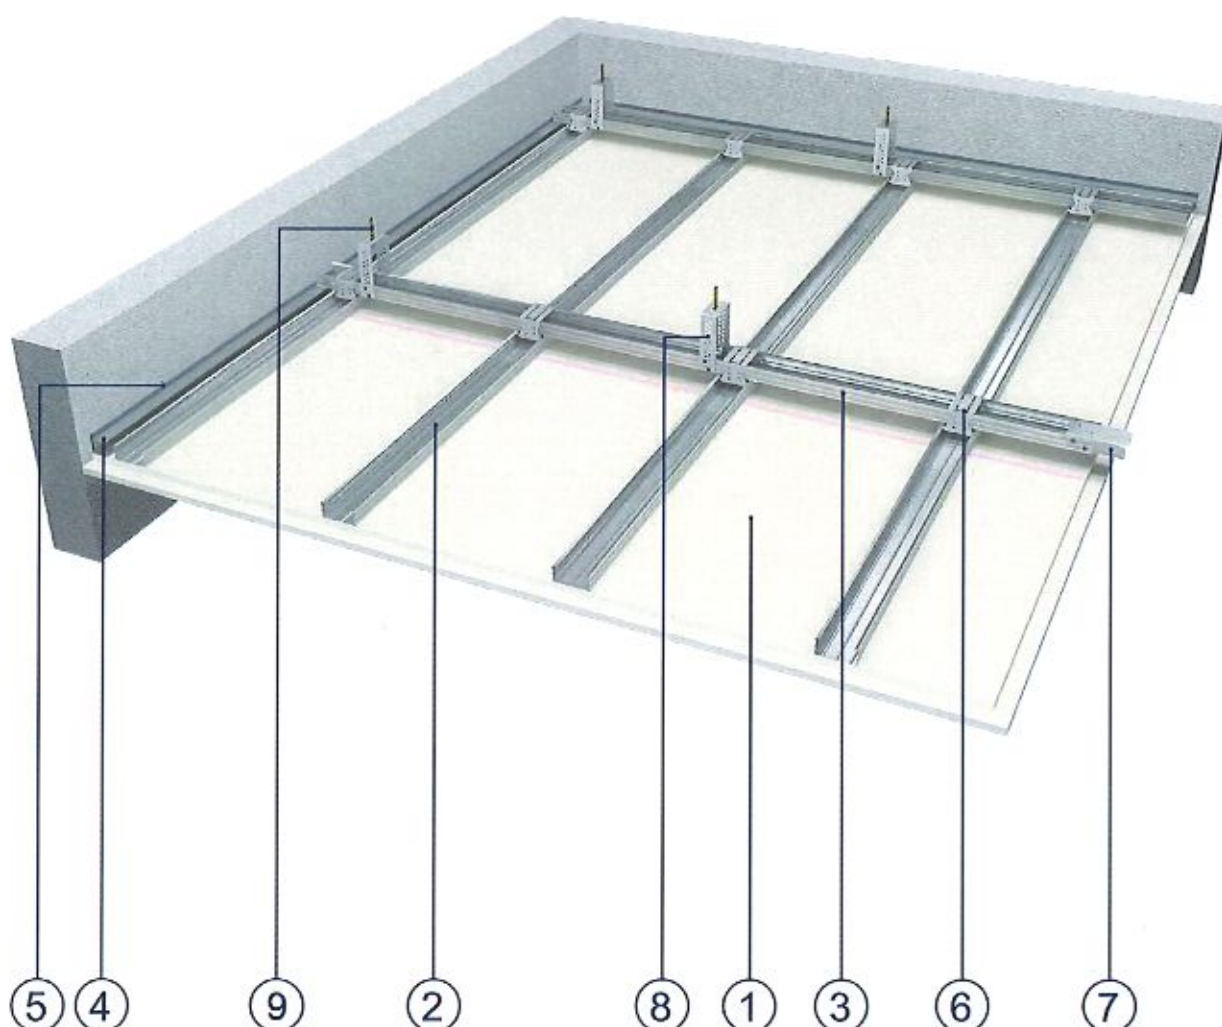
Widok sufitu podwieszanego – konstrukcja krzyżowa dwupoziomowa na wieszakach obrotowych ze sprężyną
